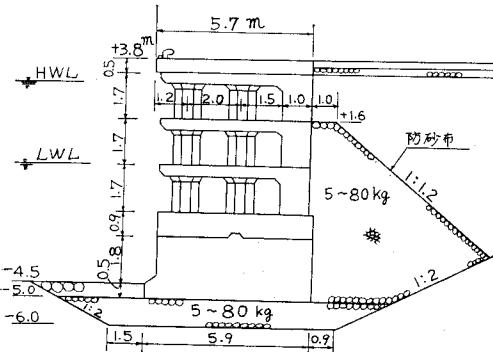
鹿児島新港 -4.5 m 岸壁標準断面図
